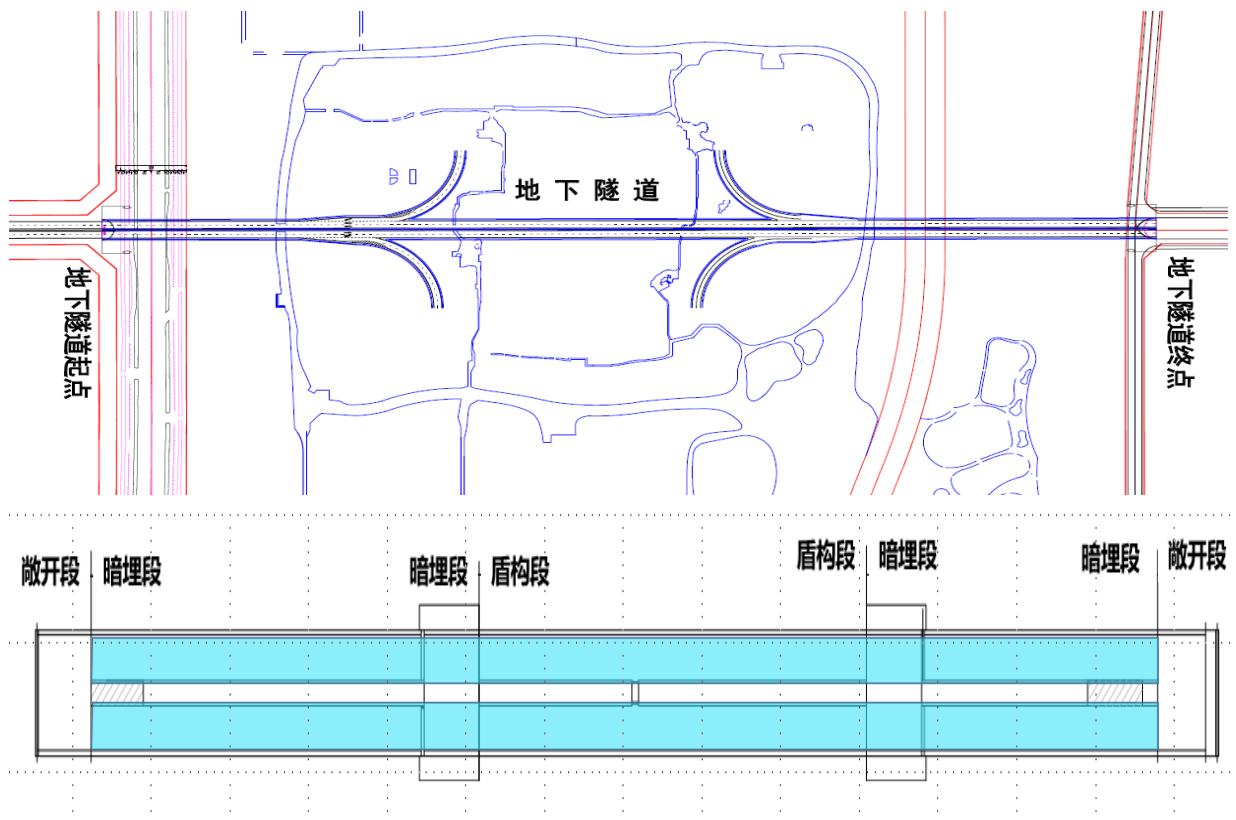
地下隧道平急两用雨水调蓄设施平面示意图
